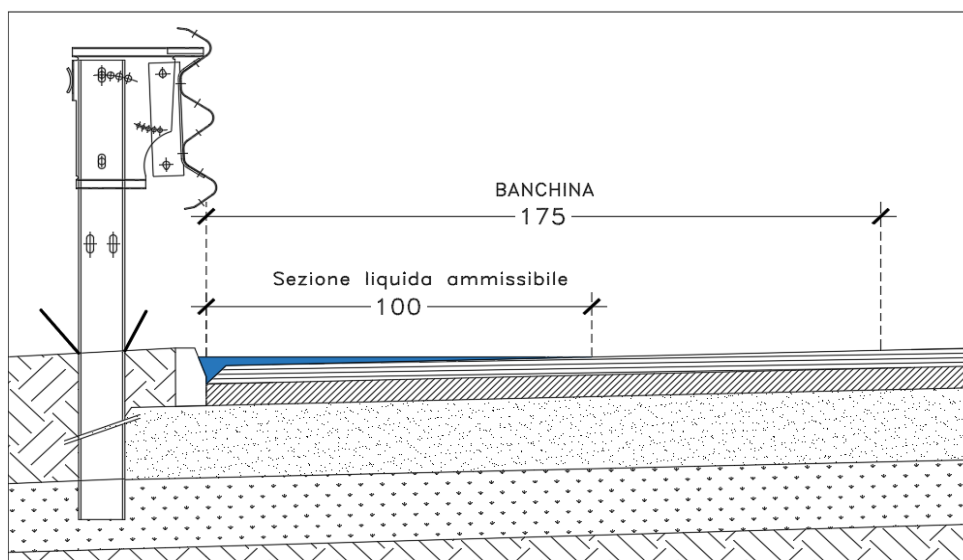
Sezione liquida in rilevato e viadotto
